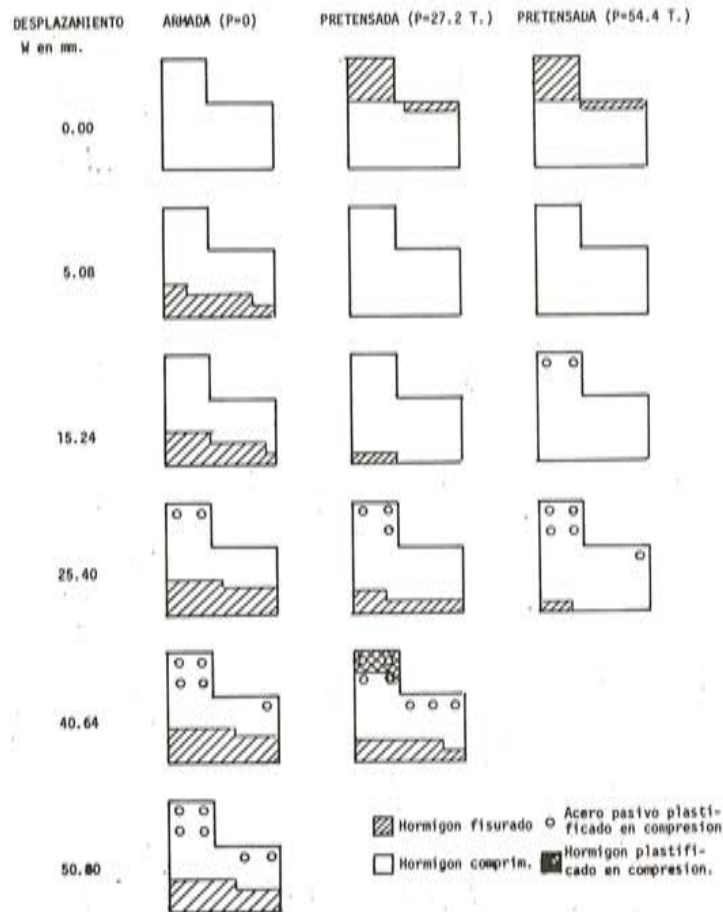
Evolución de la fisuración y estado tensional de la sección de la base.
